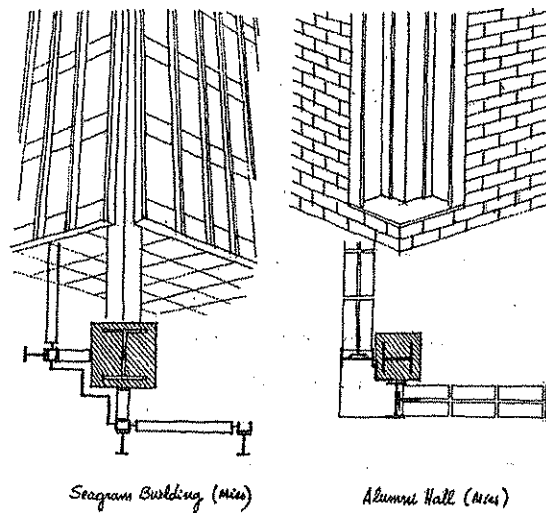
Seagram Buildingy Alumni Hall - Mies
